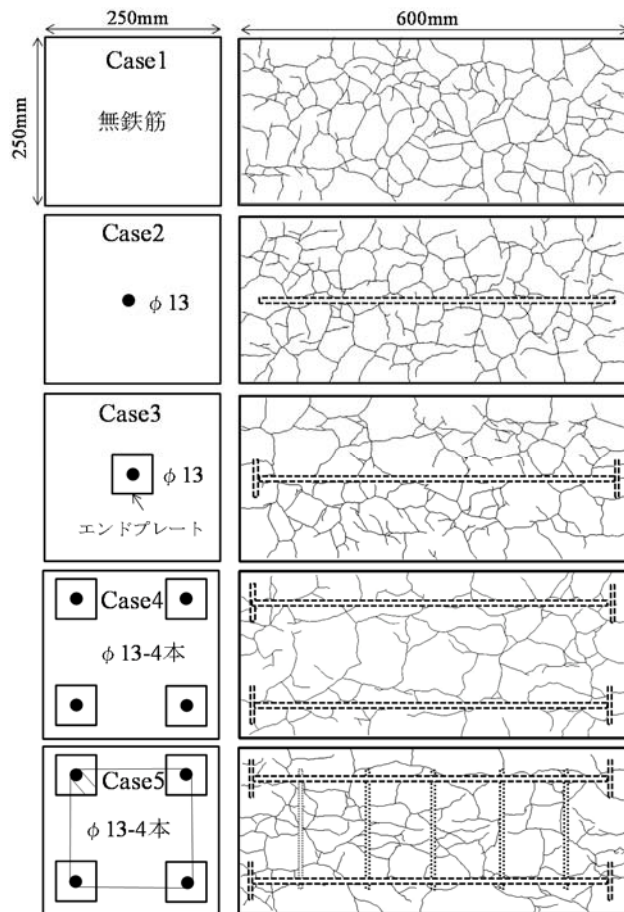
促進膨張終了後の矩形供試体表面ひび割れ図
